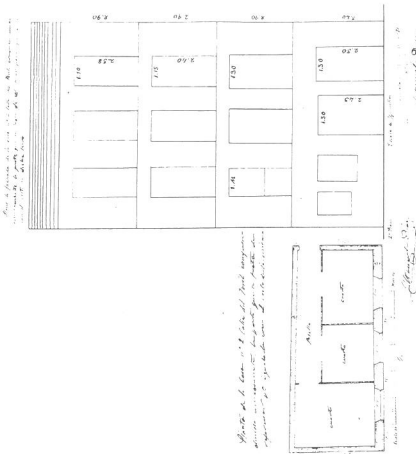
Proyecto de planta y alzado para c/ Toril nº 2, M. Díaz, 1871.
